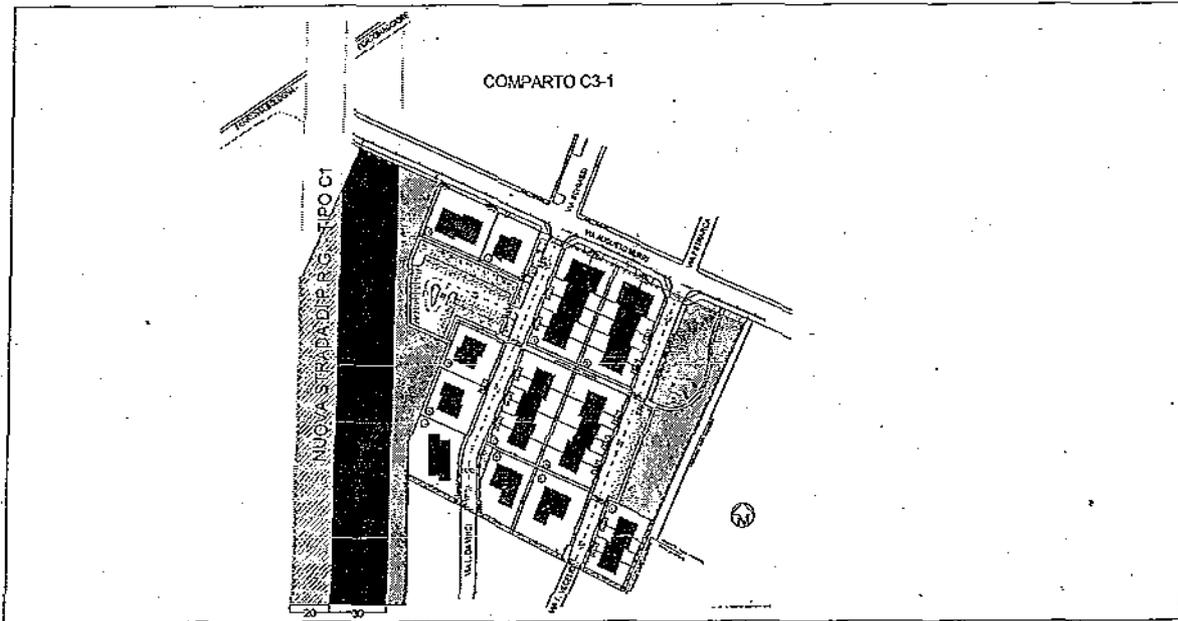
Tavola di Progetto del Piano Particolareggiato in variante in approvazione
